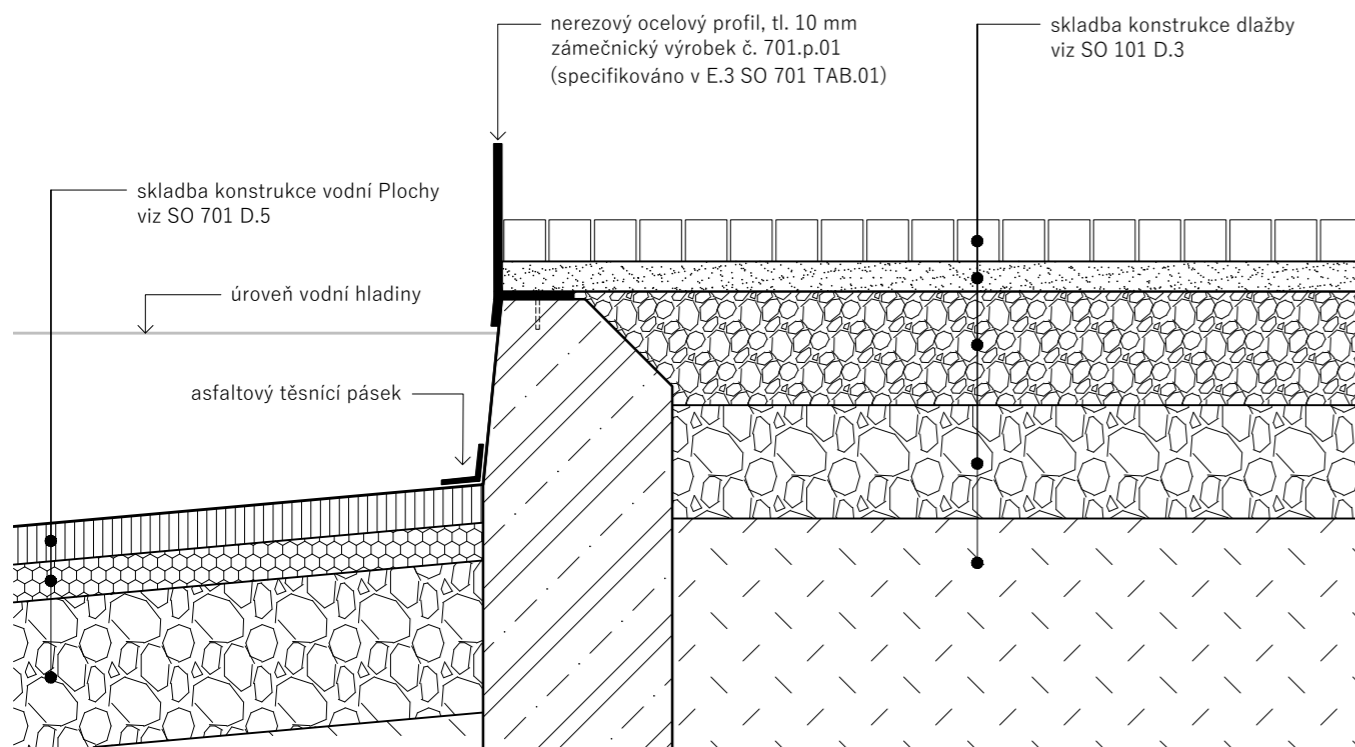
DETAIL OKRAJE VODNÍHO ZRCADLA S DLAŽBOU M 1:10
